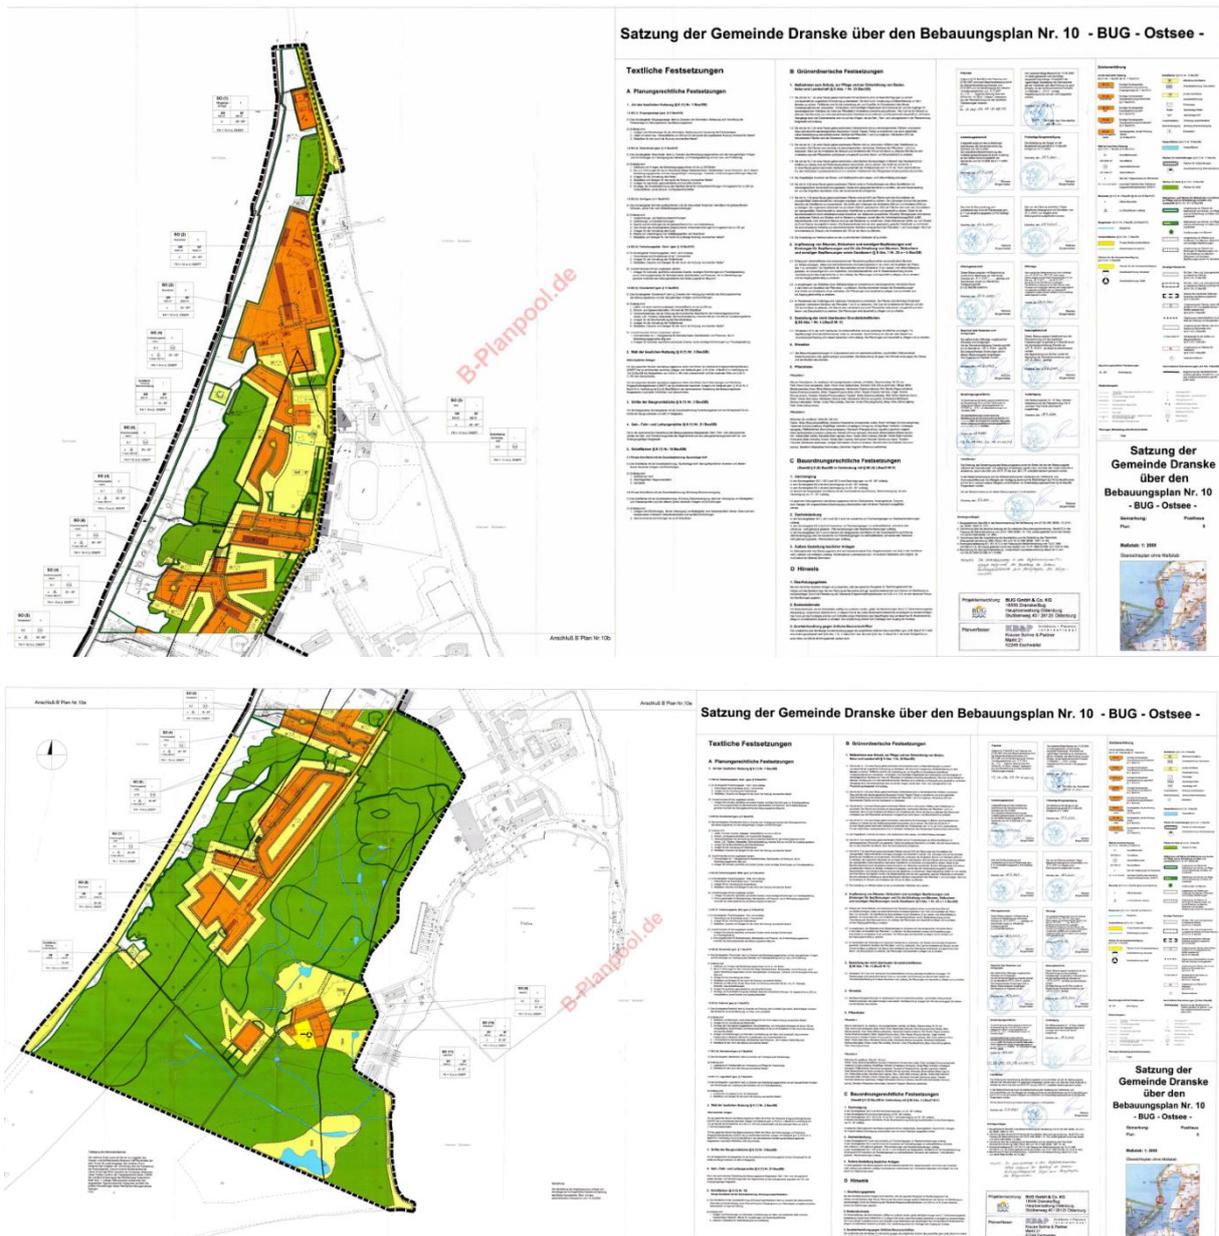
und 6: Planzeichnungen des Bebauungsplans Nr. 10 Bug-Ostsee. Anschluss b (oben) und Anschluss A (unten), Originalmaßstab 1:1.000
